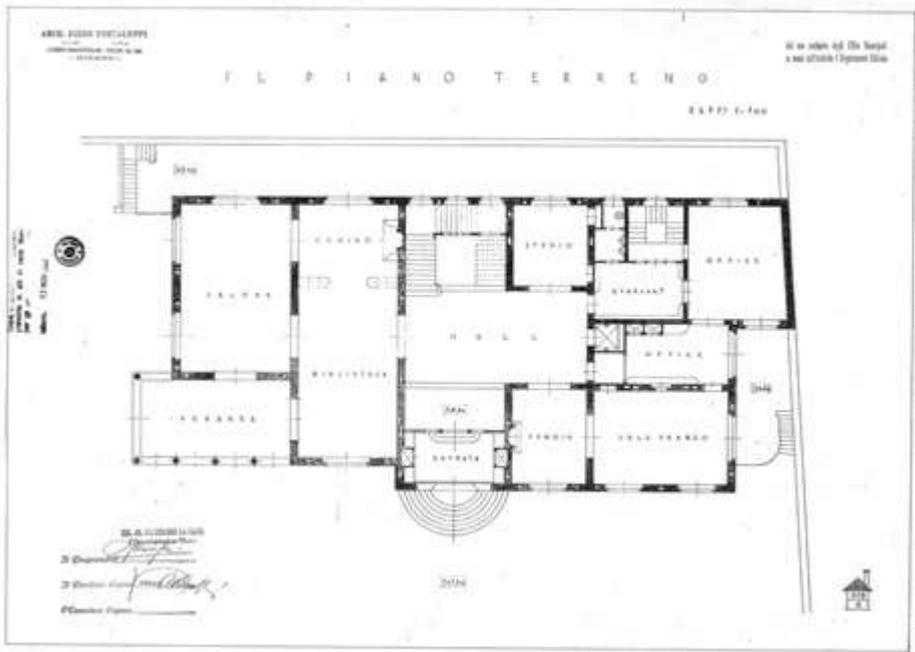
Grundrisse Villa Necchi Campiglio, Zeichnung: Piero Portaluppi
